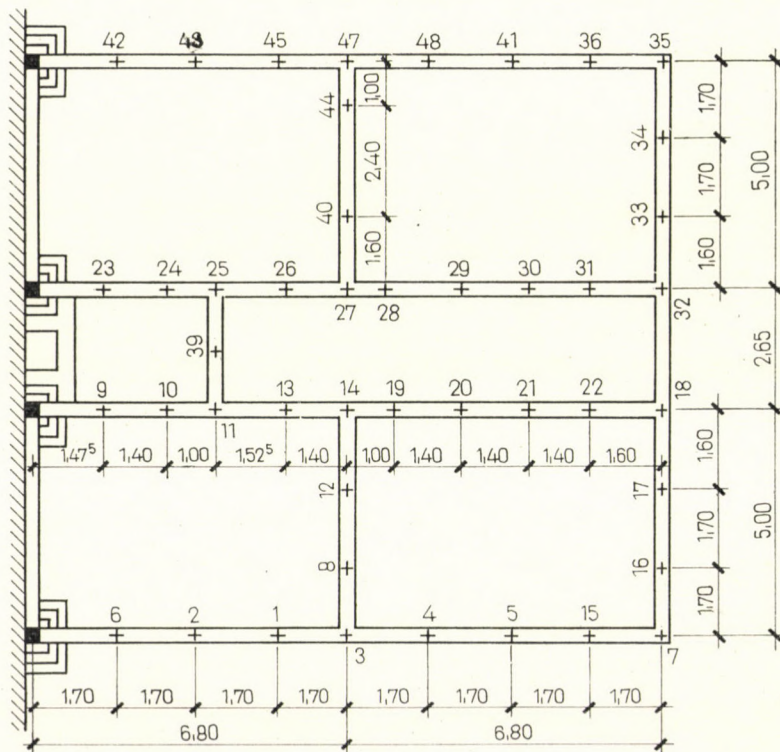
Lageplan der Pfähle für das Wohnhaus in Arad, Filimon Sirbu Straße
